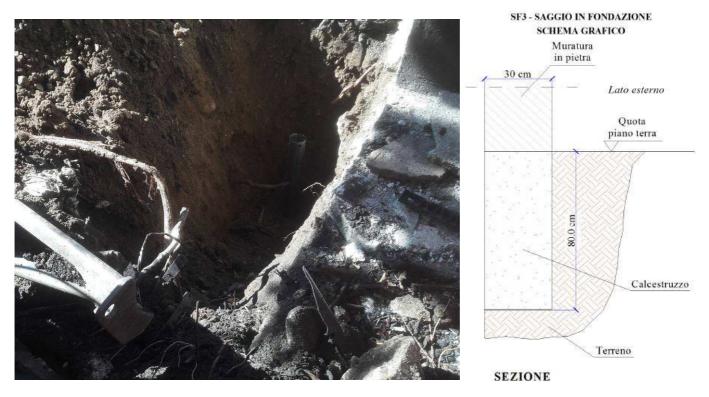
Indagine SF3 (saggio in fondazione) del Blocco C: è stata rilevata una fondazione in cls di altezza pari a 80 cm.
